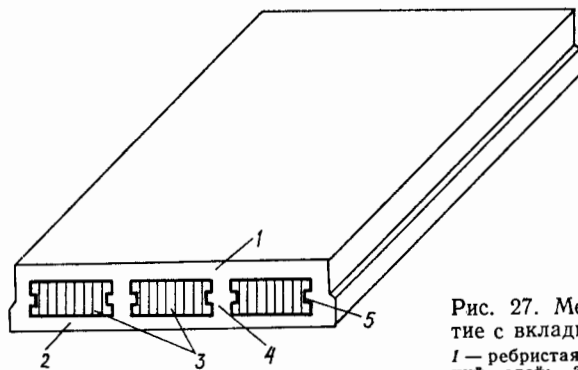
Междуэтажное перекрытие с вкладышами:
